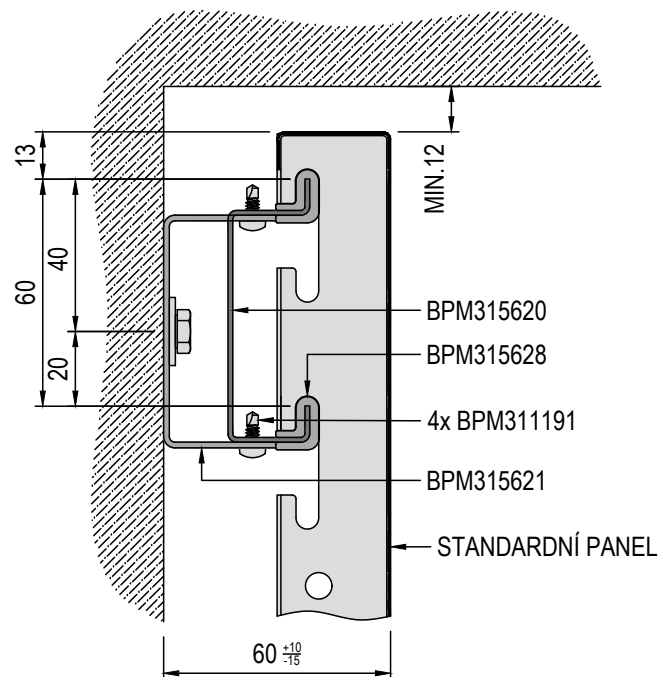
UKONČENÍ U OKENNÍHO PARAPETU
